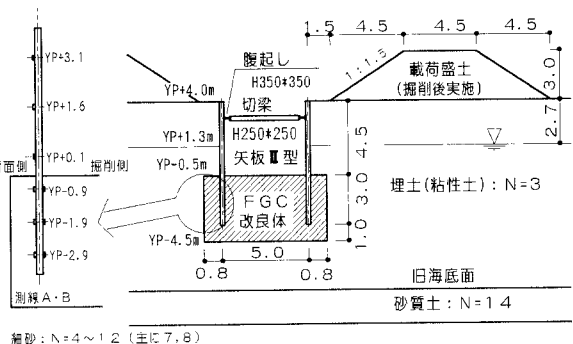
現場実証試験の断面図(X-X断面, 単位:m)
